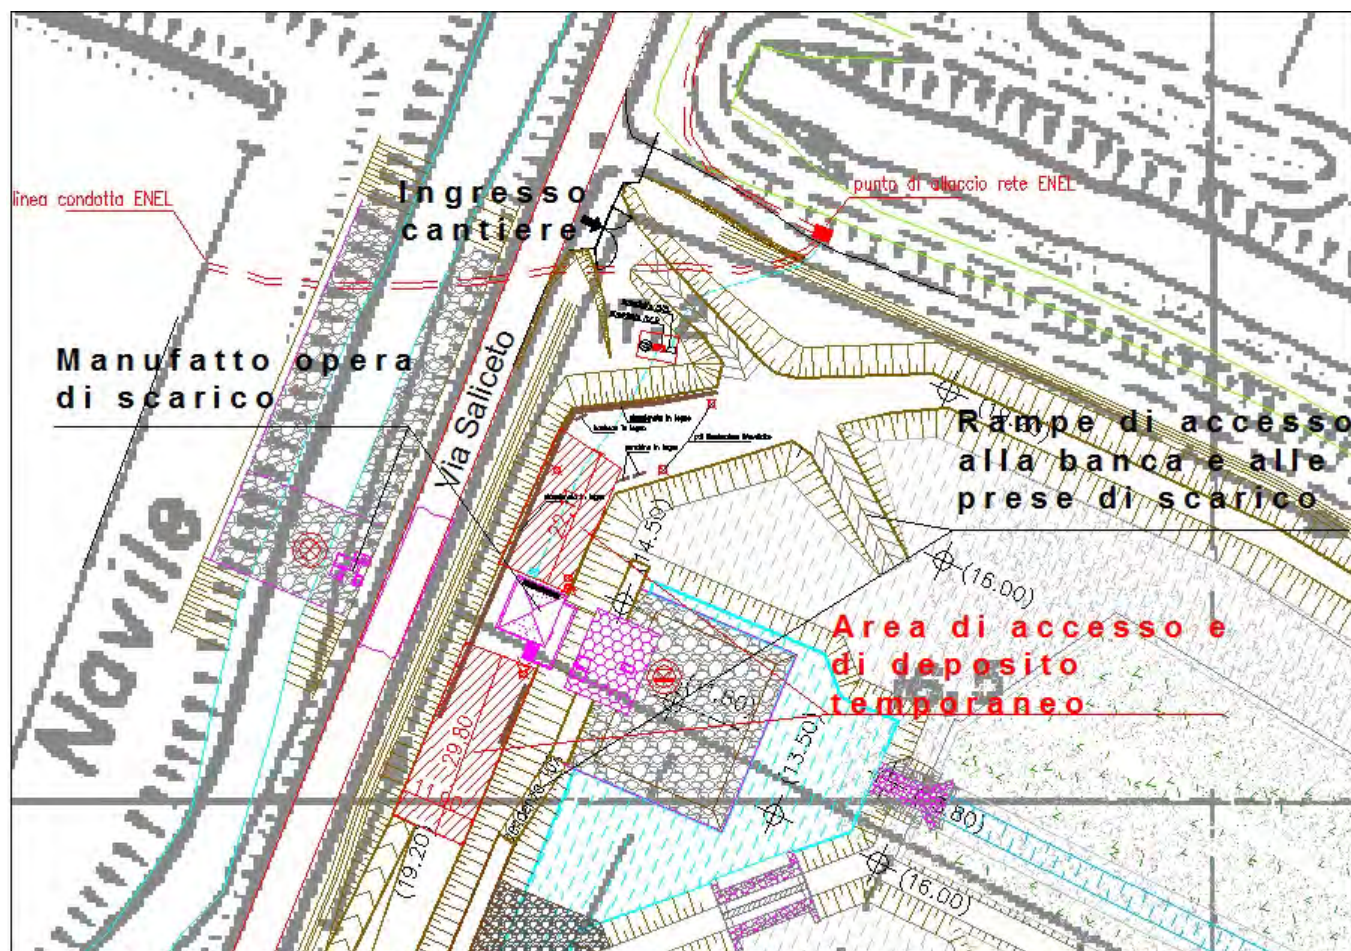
Planimetria dell'area di cantiere con area di manovra per l'installazione delle attrezzature
